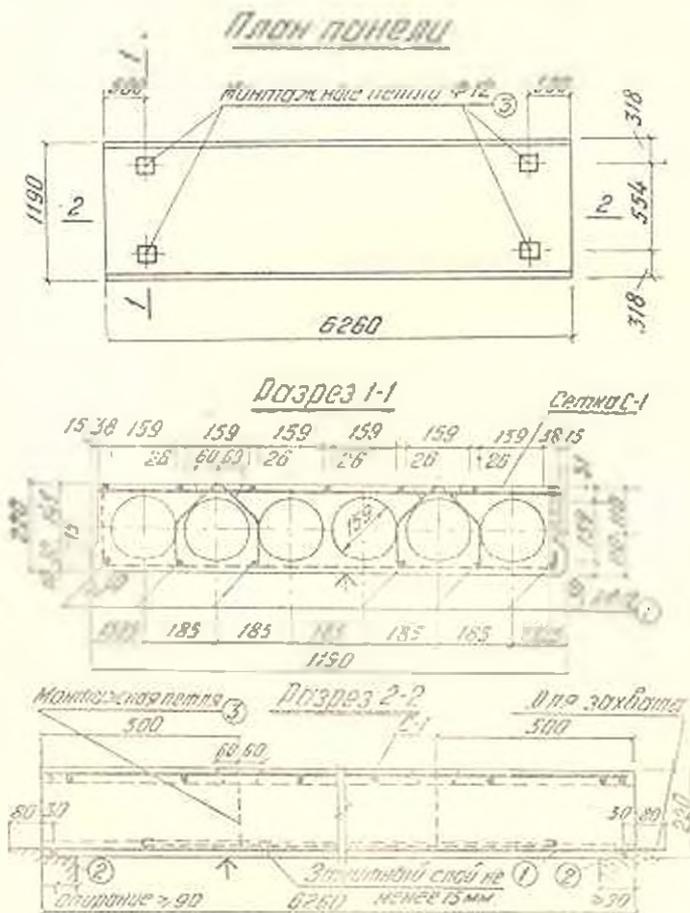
Конструкция междуэтажного железобетонного перекрытия с предварительно напряженной арматурой.
